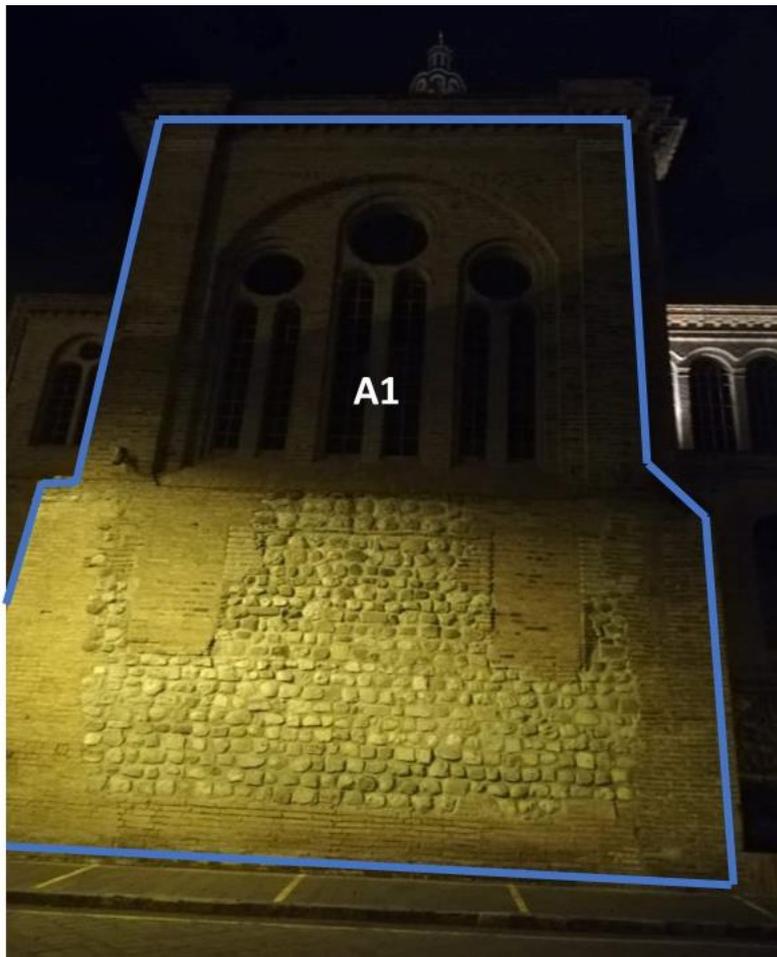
Sección de la fachada lateral 1 iglesia San Blas. [Autores]
